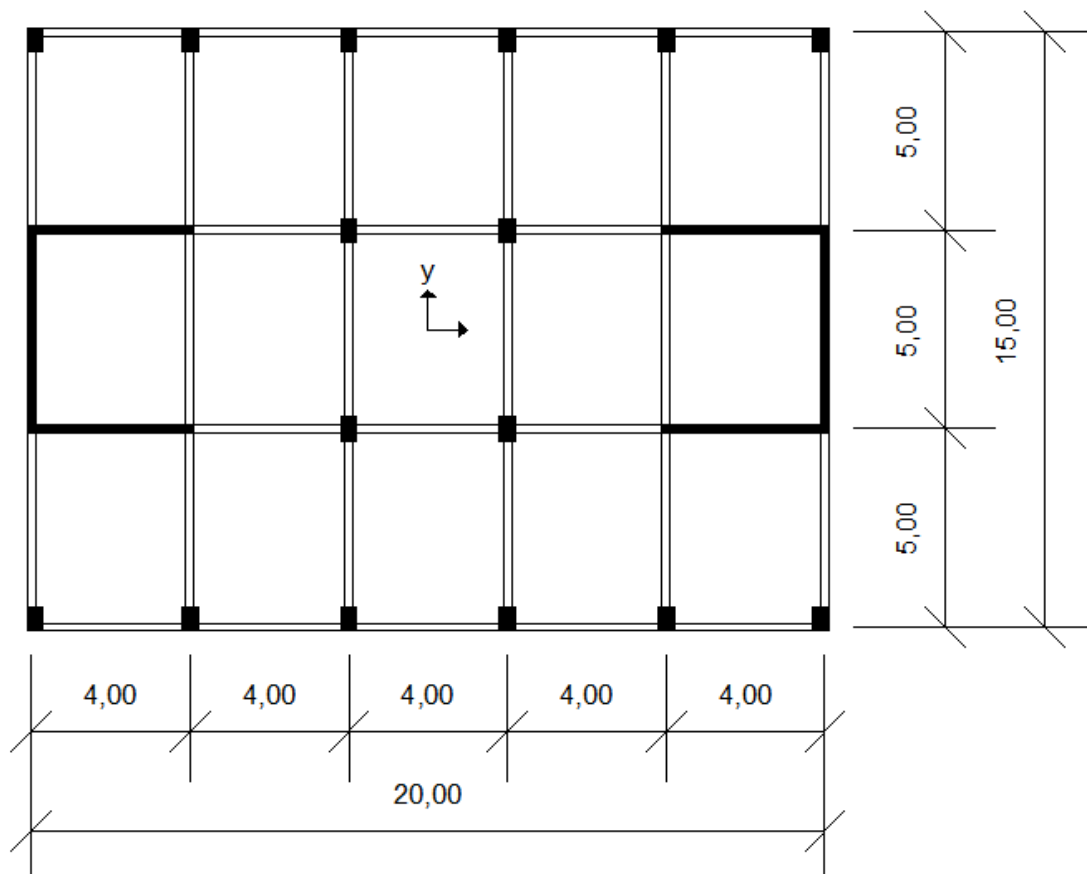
Disposição em Planta dos Elementos Estruturais do Edifício 2NL8
